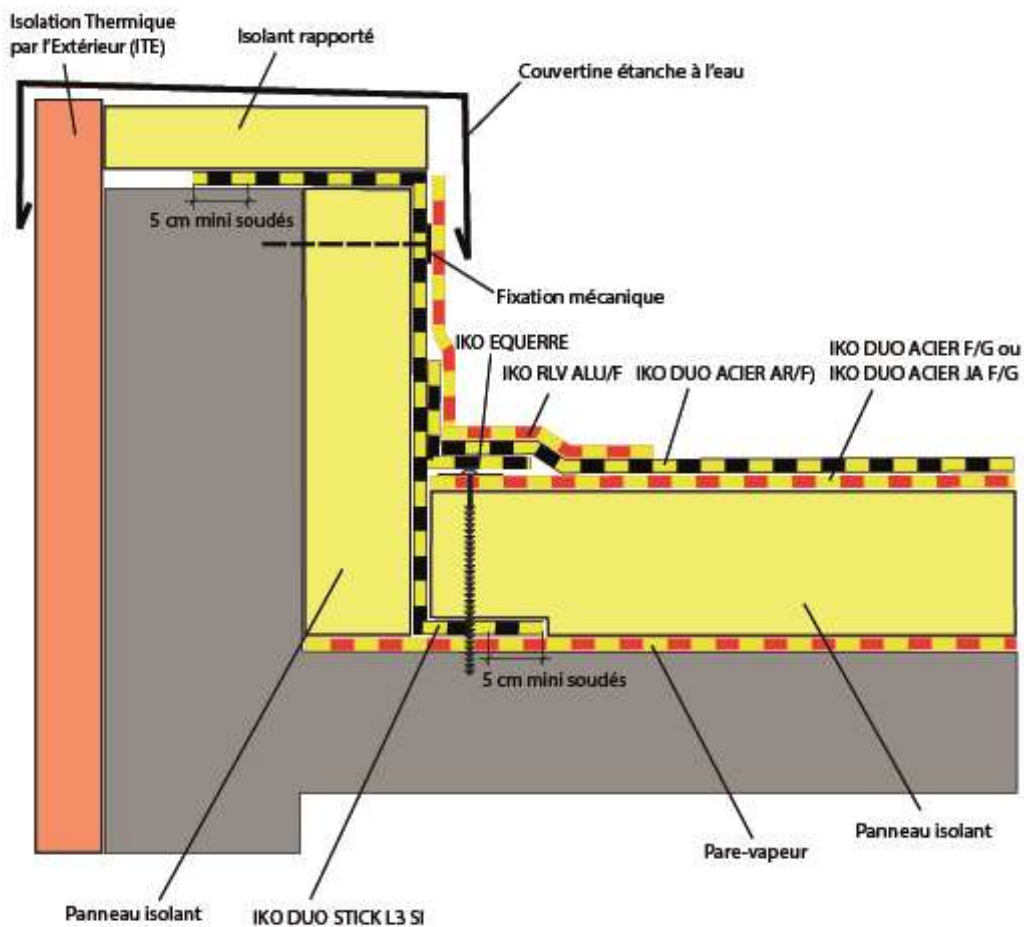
Exemple de relevé d'étanchéité sur isolant PUR / PIR admis par son DTA sous revêtement autoadhésif apparent avec élément porteur en béton (variante)
